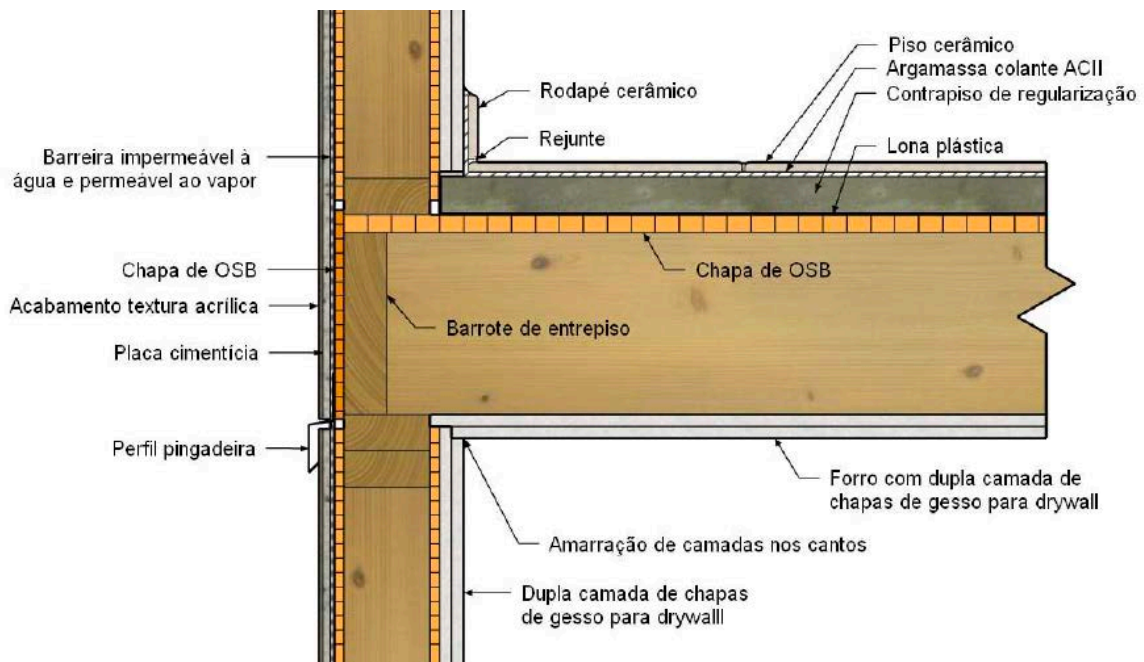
Detalhe em corte da disposição das duas camadas das chapas de gesso para *drywall* na interface das paredes com o forro em edificações multifamiliares.
